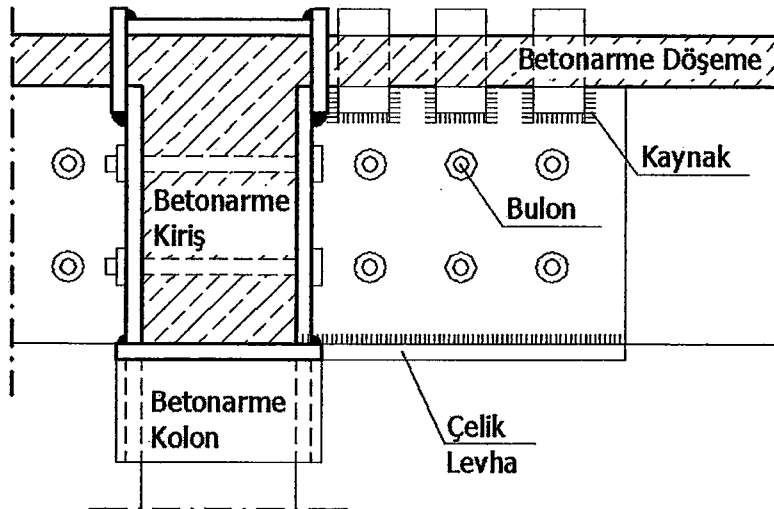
Profillerin kiriş yan yüzüne bağlantısı
